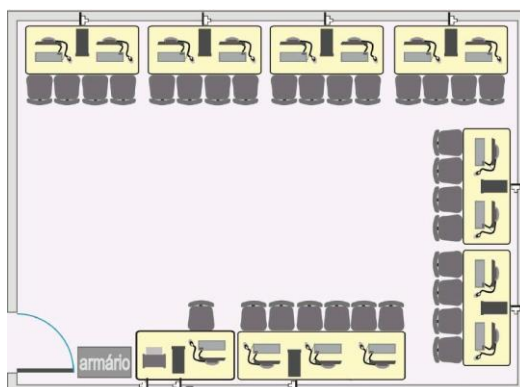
Sugestão de layout do ProInfo para laboratório de informática
